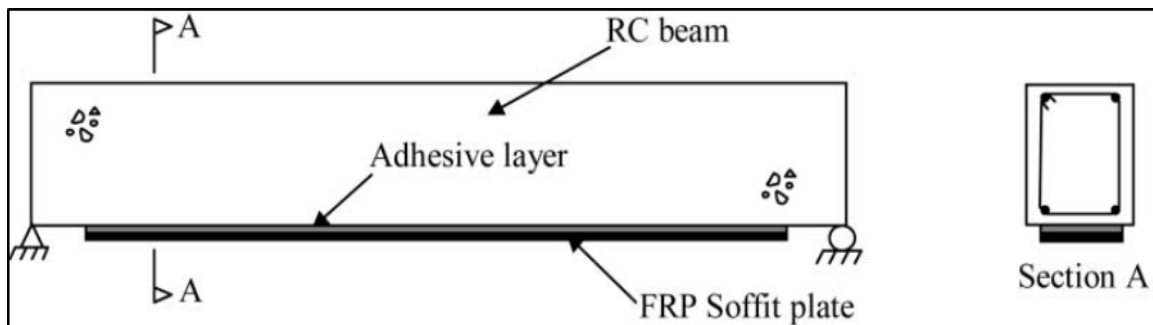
Poutre en béton armé renforcée par une lamelle en PRF [36]
